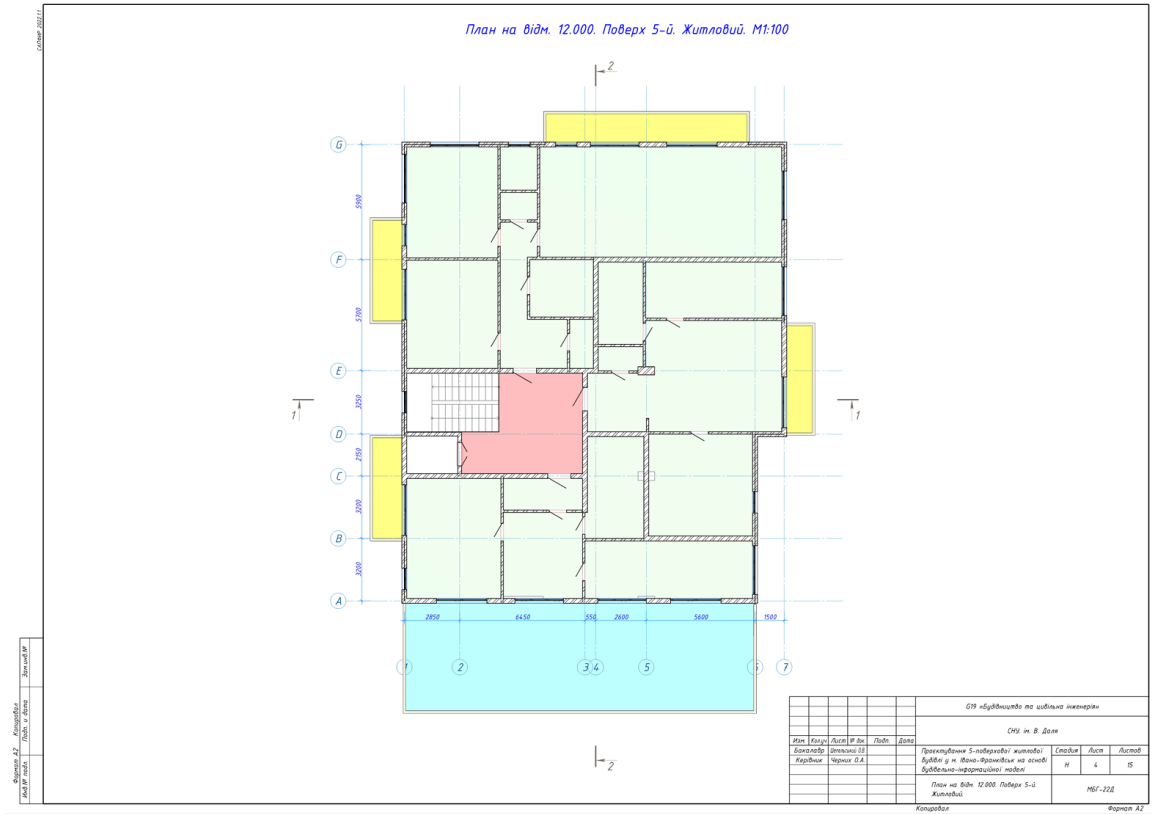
План на відм. 12.000. Поверх 5-й. ЖИТЛОВИЙ.
